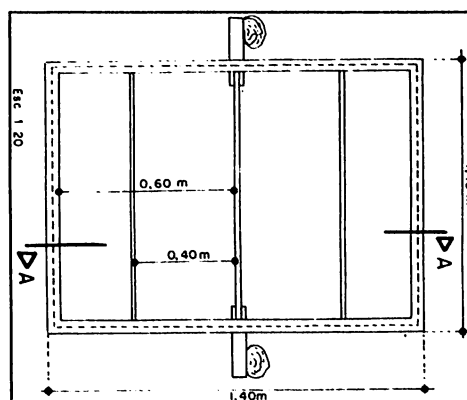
Planta baixa do saleiro automático-unidade (SA-1)
